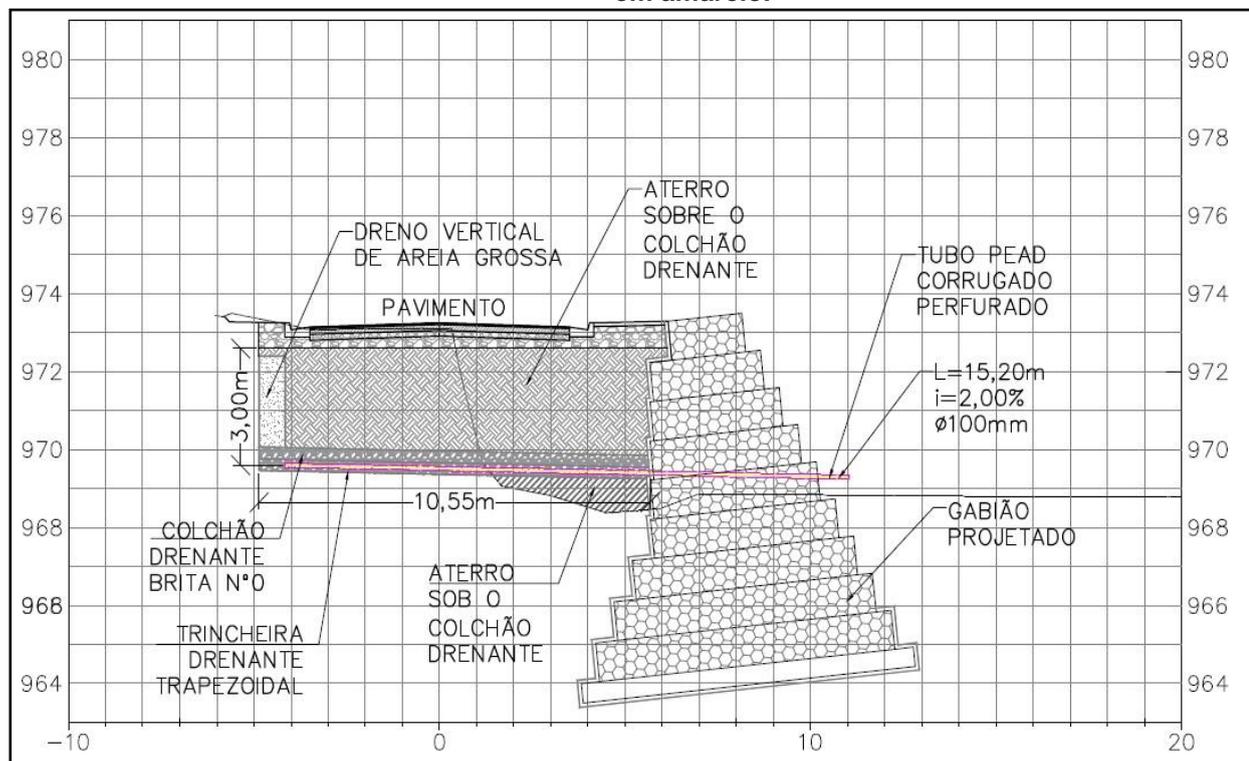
Corte transversal do sistema de drenos a ser executado.
